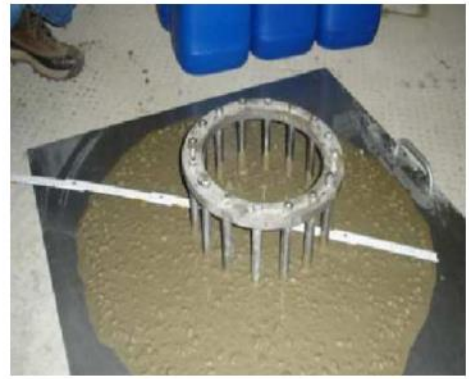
Самоущільнювальна бетонна суміш
